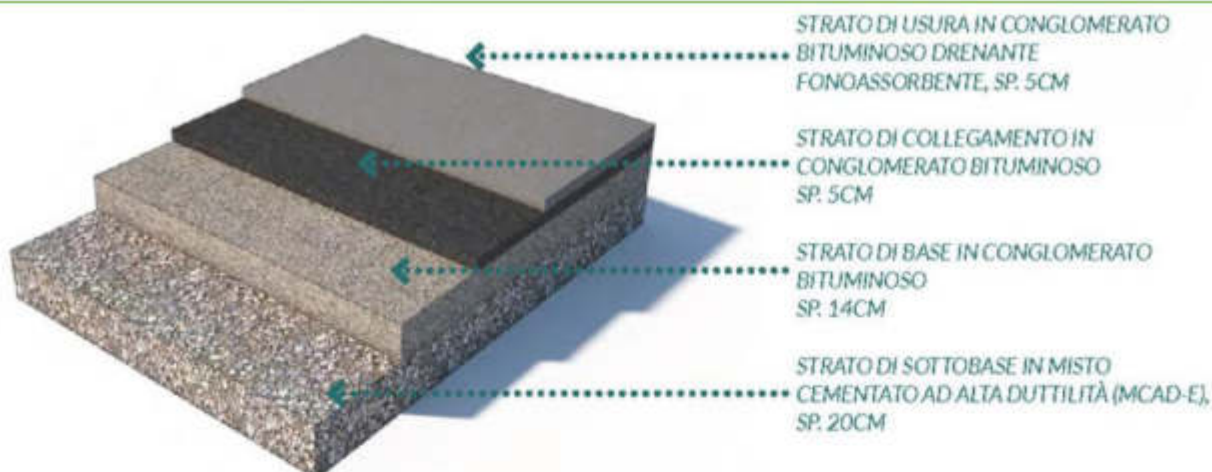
Struttura Nuova Pavimentazione in asfalto drenante
